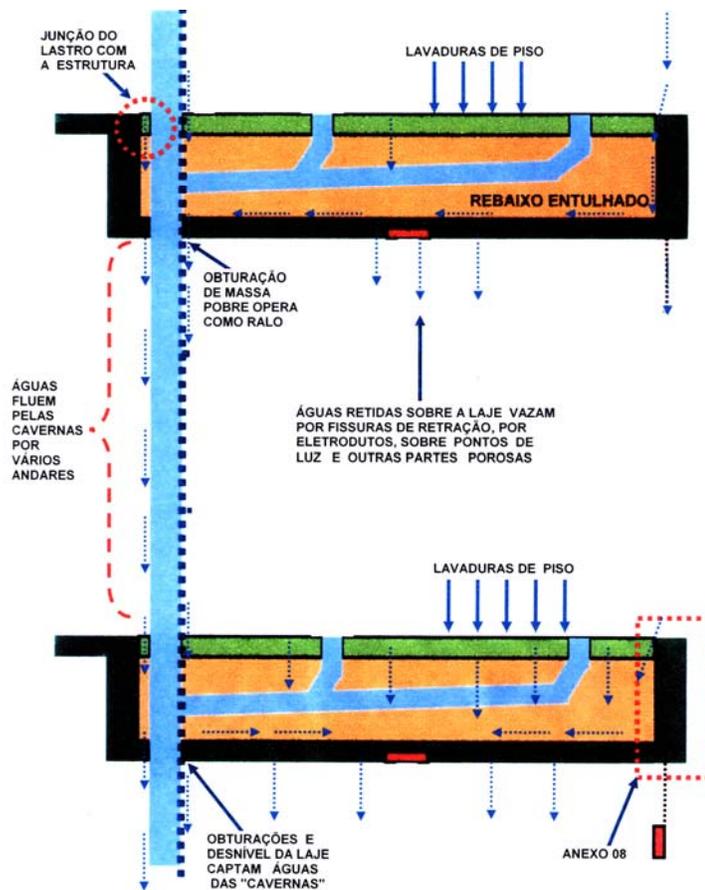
Infiltração de água em lavagens de piso não impermeabilizado (Fonte: Acervo Arqº Sylvio Rocha Nogueira)
